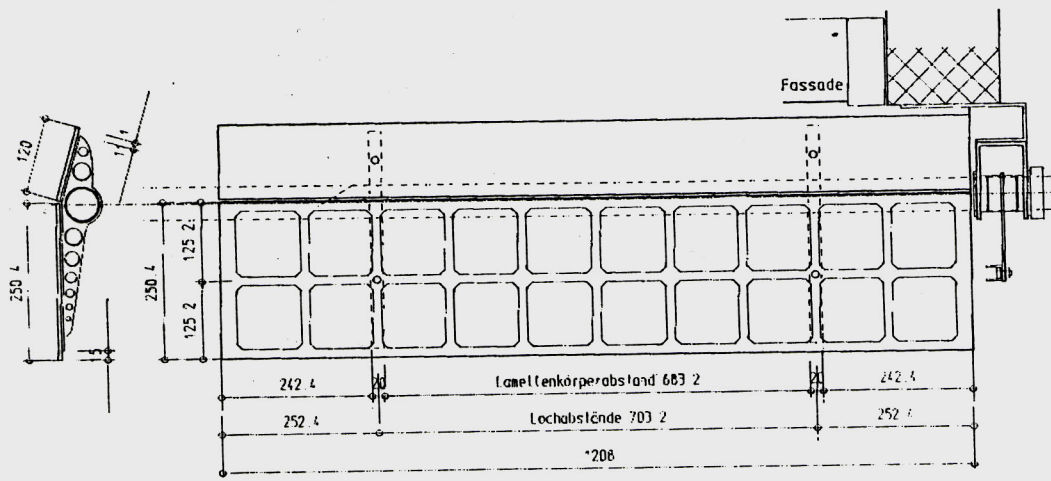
Vue en plan et détail d'un élément brise-soleil photovoltaïque.
